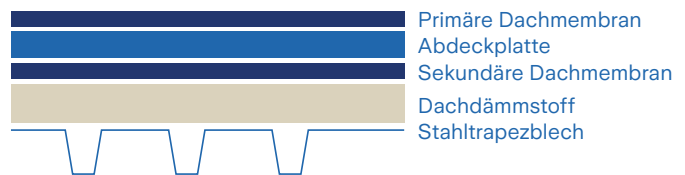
Abdeckplatte über brennbarem Dachaufbau
